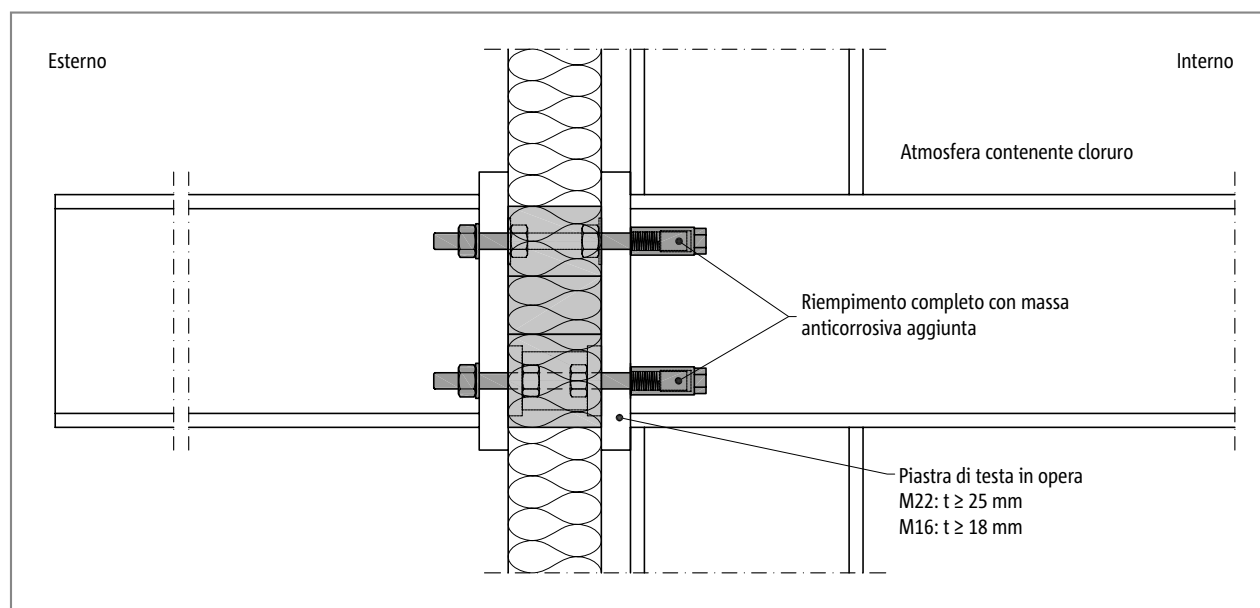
Schöck Isokorb® T tipo S con ghiera di bloccaggio: costruzione in acciaio a sbalzo; interno contenente cloruro
